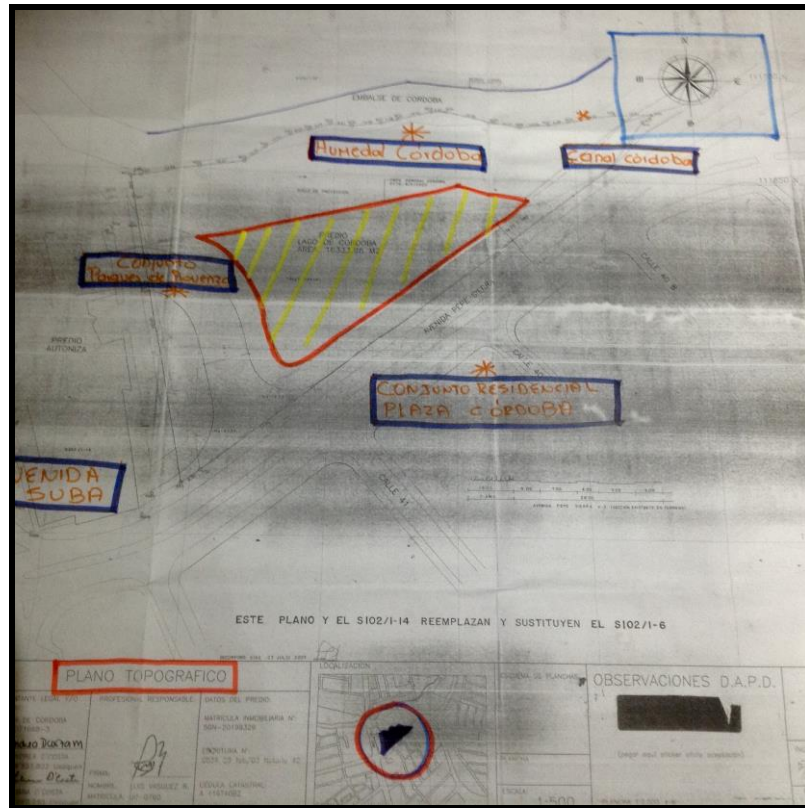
Plano de localización-Linderos. Fuente: construcción autores
